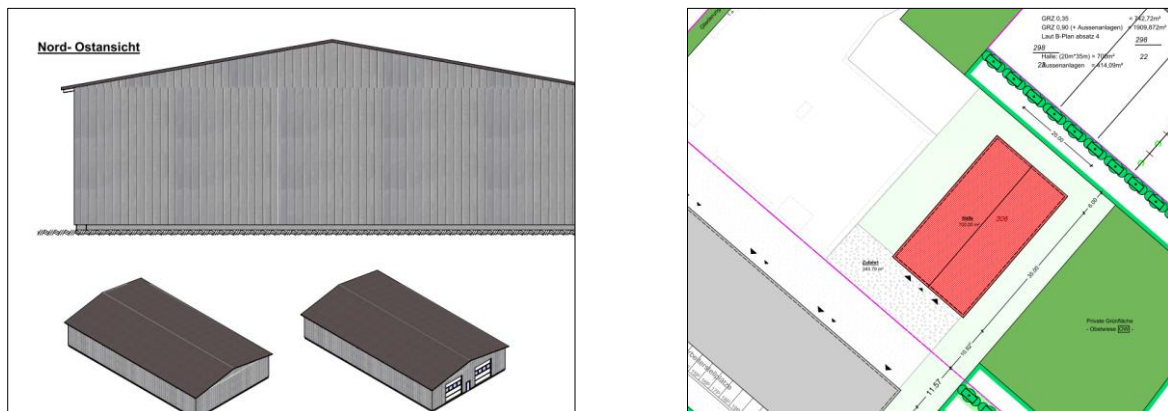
+12: Ausschnitte aus den Bauantragsunterlagen Stand Mai 2019 – Dipl.Ing.Koll, Schülp ⁴
